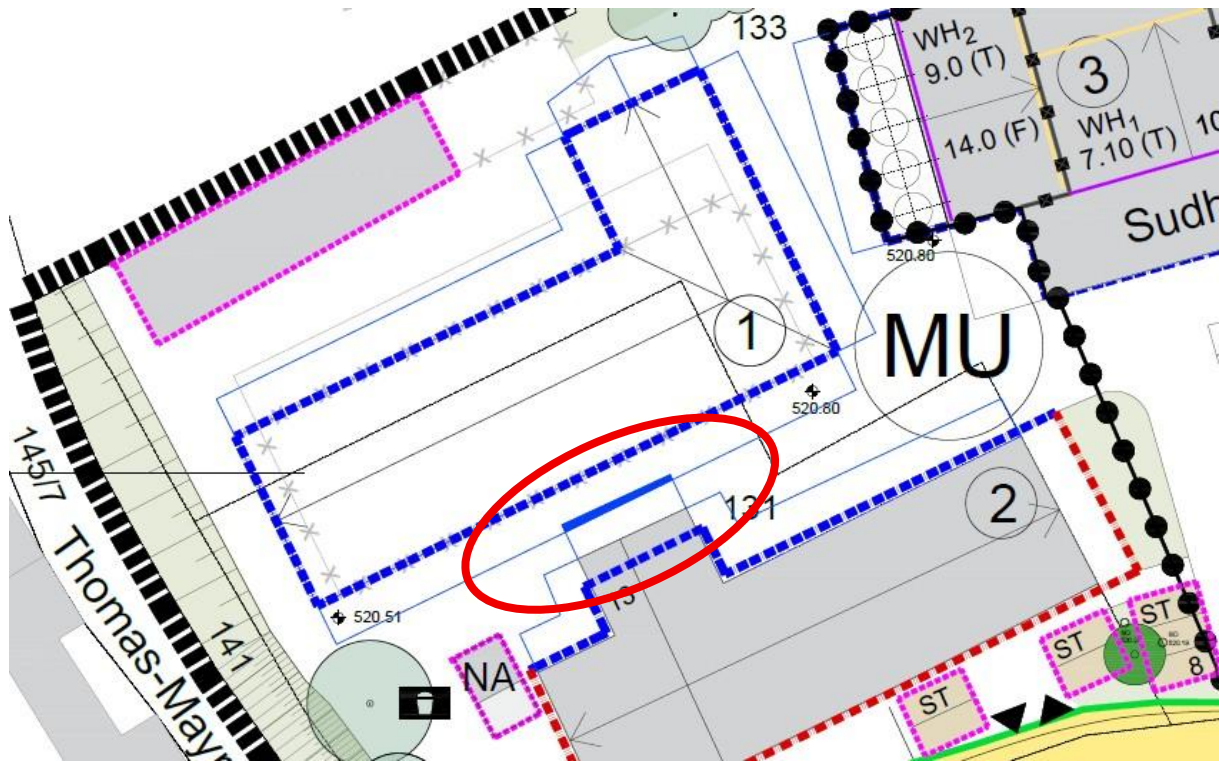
; Planzeichnung mit Abbildung der Abstandsflächen; Quelle: ASP Sept. 2025
